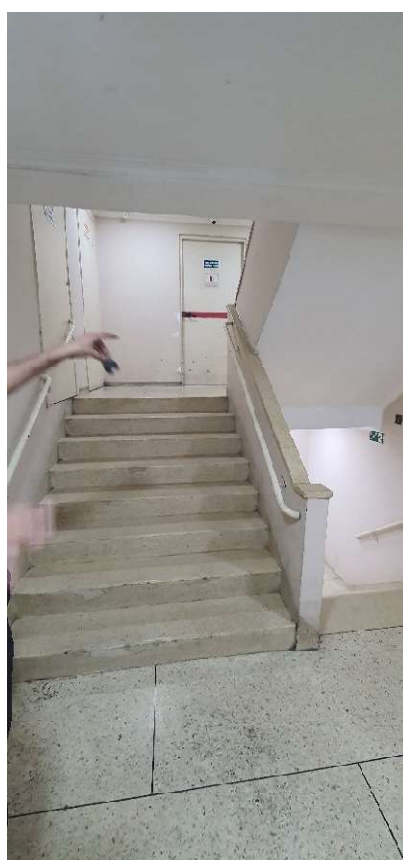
ACESSO DO HALL DO ELEVADOR PARA O HALL DO PAVIMENTO.
